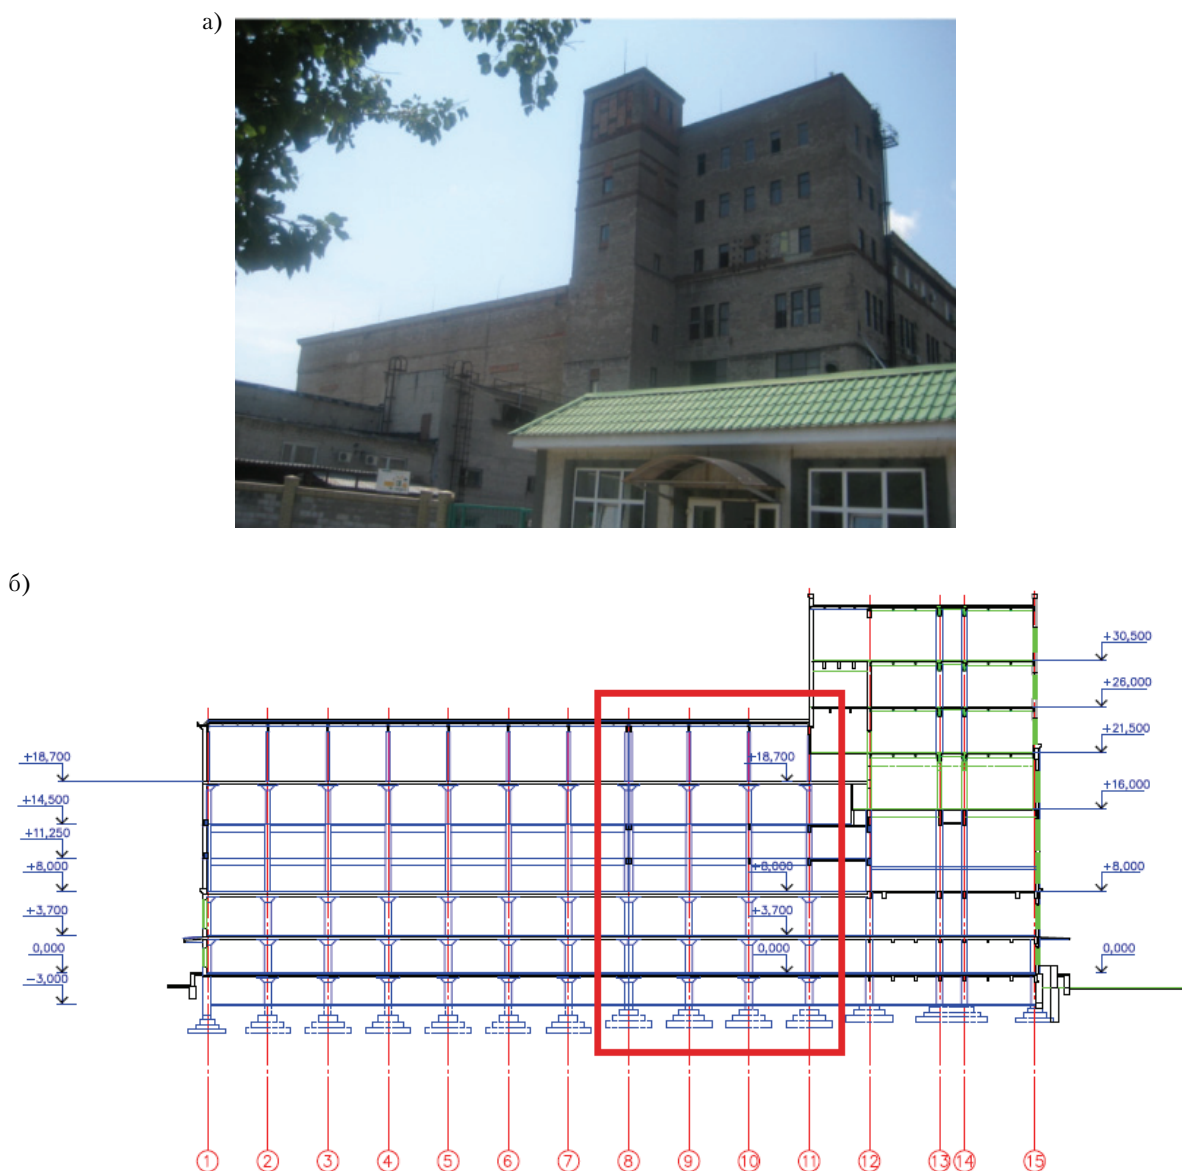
Главный корпус пивоваренного завода: а) общий вид здания главного корпуса завода «Сармат»; б) часть завода, предназначенная для технического перевооружения.
